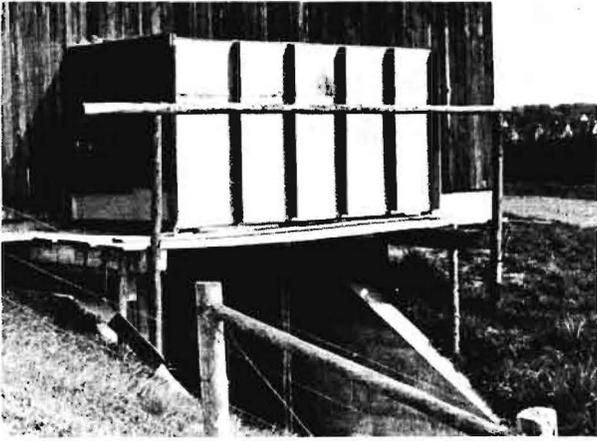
Schalldämmkanal aus Preßspanplatten mit schallschluckender Auskleidung
